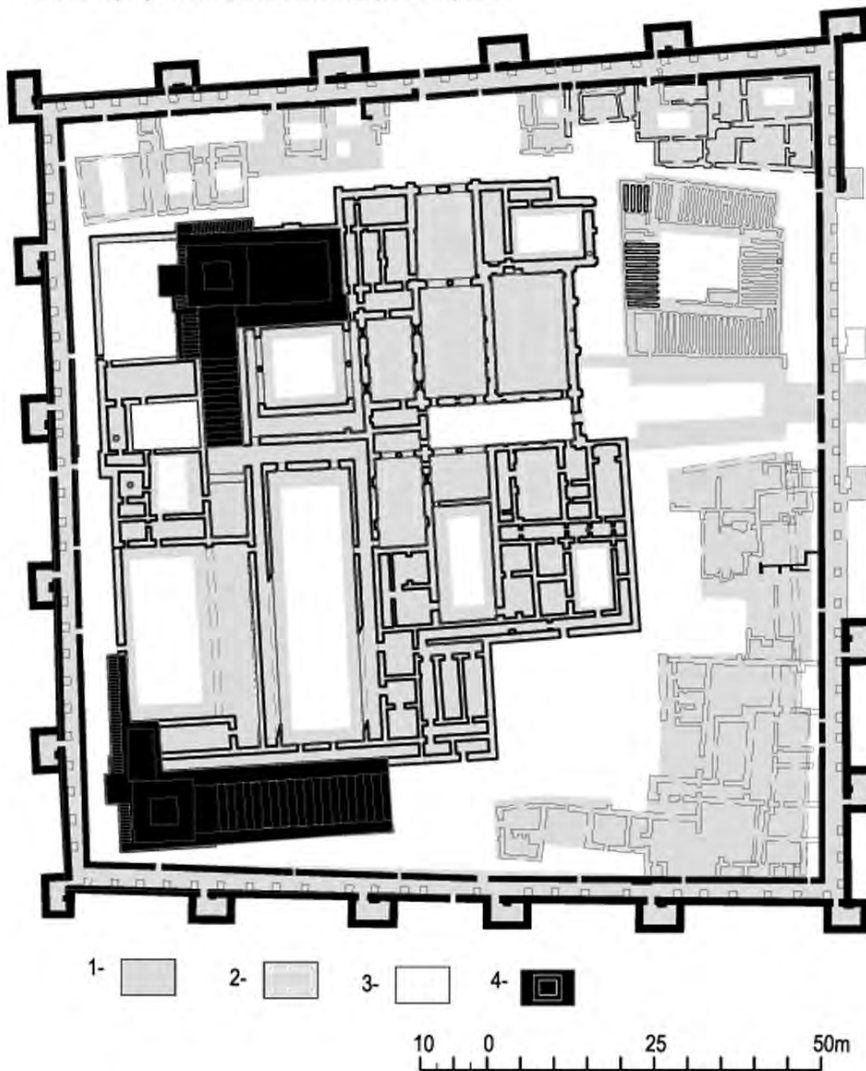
КРЕМЛЬ. Схема организации перекрытий и световых колодцев.
